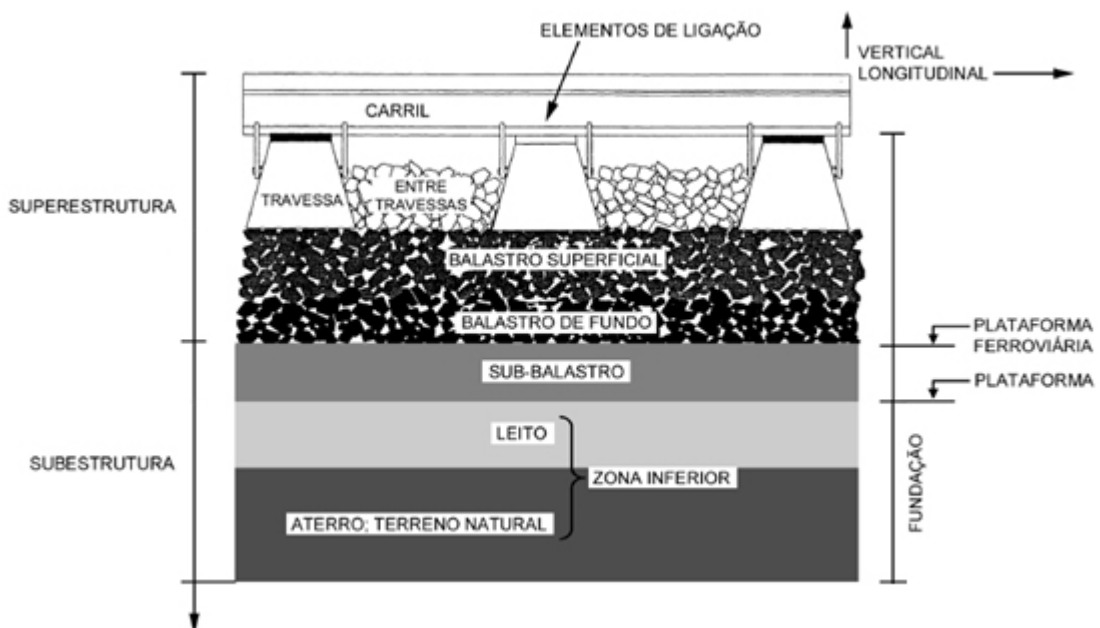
Perfil Longitudinal de Via Ferroviária Balastrada, adaptado (Fortunato, 2005)
